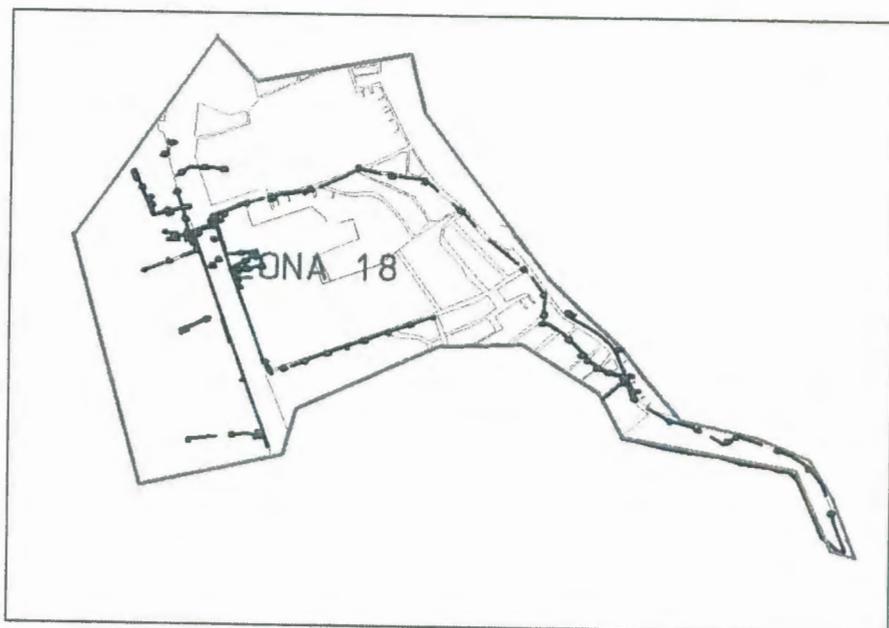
Planimetría zona 18 del sector de la vía a Daule
